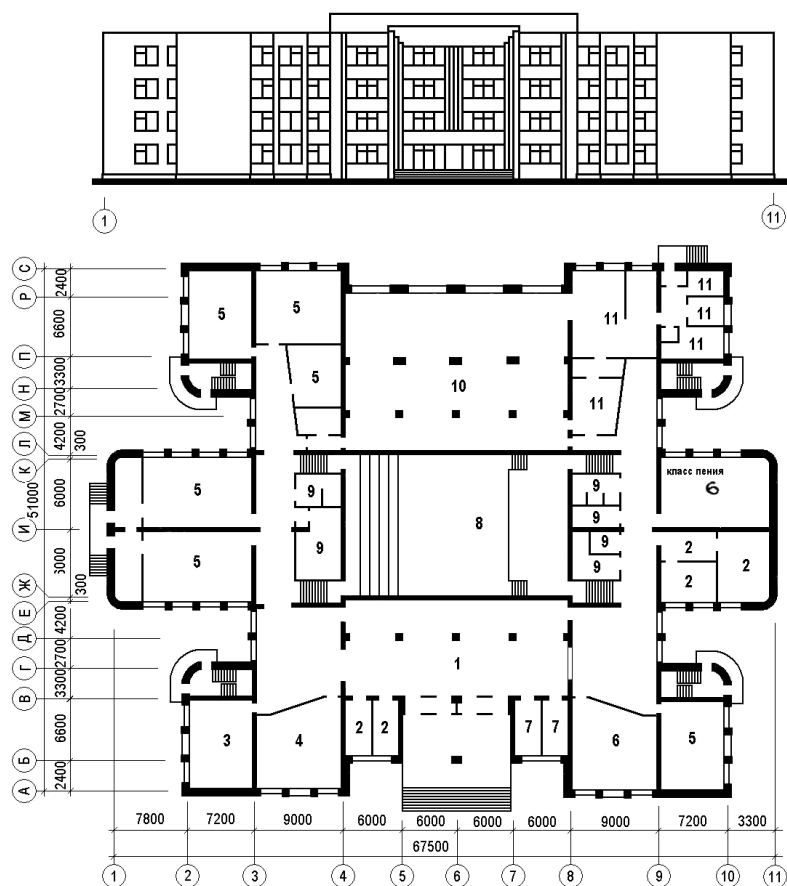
Школа на 44 класса. Типовой проект. Фасад. План первого этажа:
